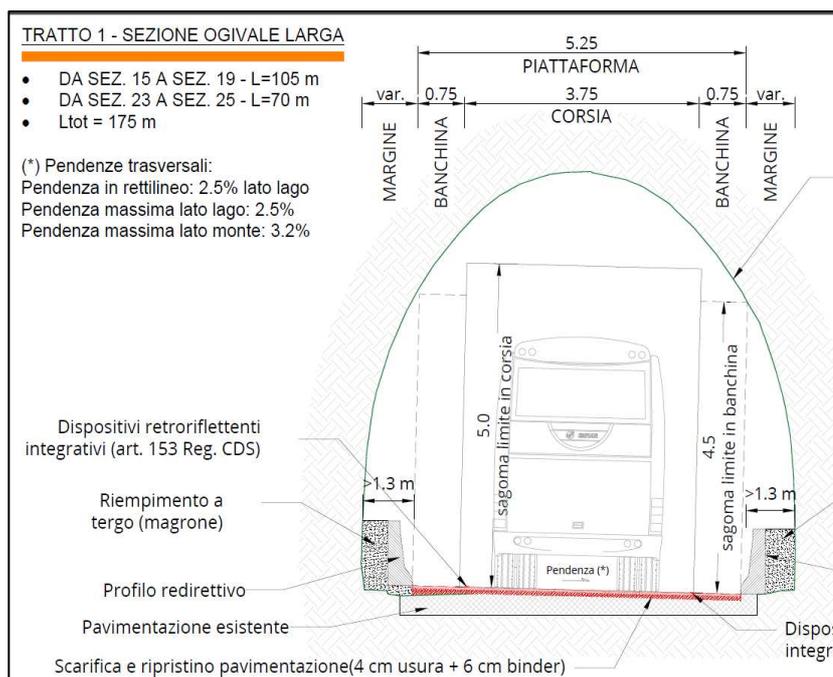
Sezione tipo adeguamento galleria esistenti
